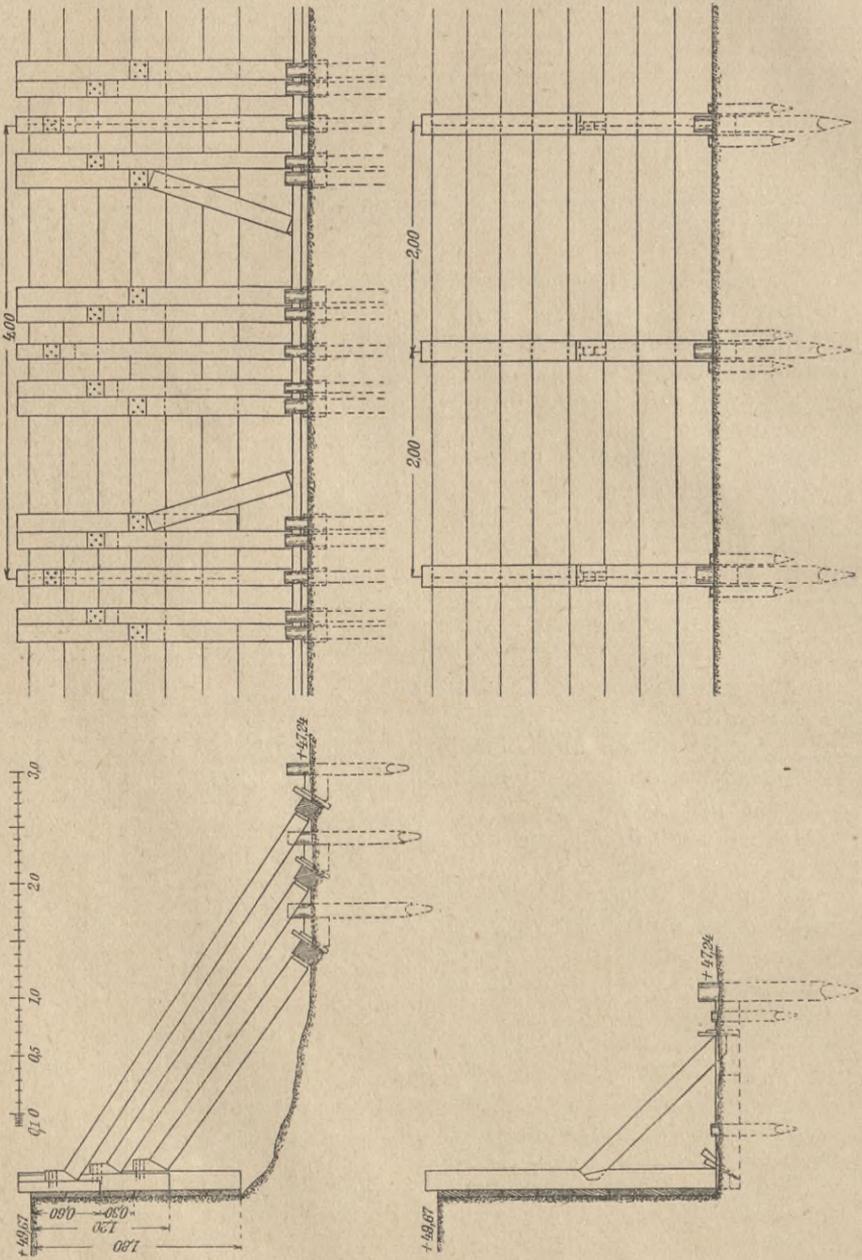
Wagerechter Verban einer freistehenden Baugrubenwand.
